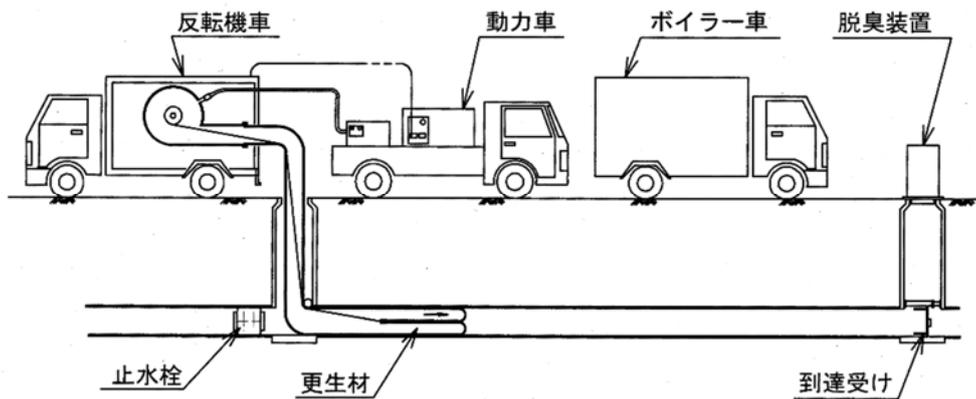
熱硬化タイプ（反転工法）の標準施工図
